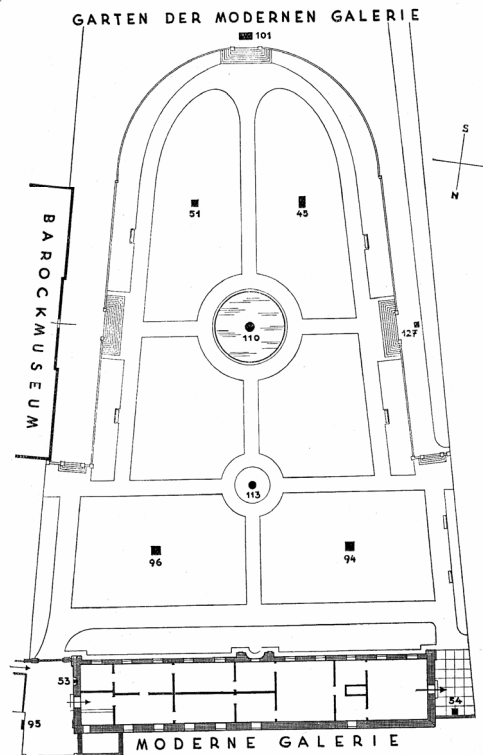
Orangerie, Belvedere Wien, Grundriss „Moderne Galerie“ und Kammergarten.
